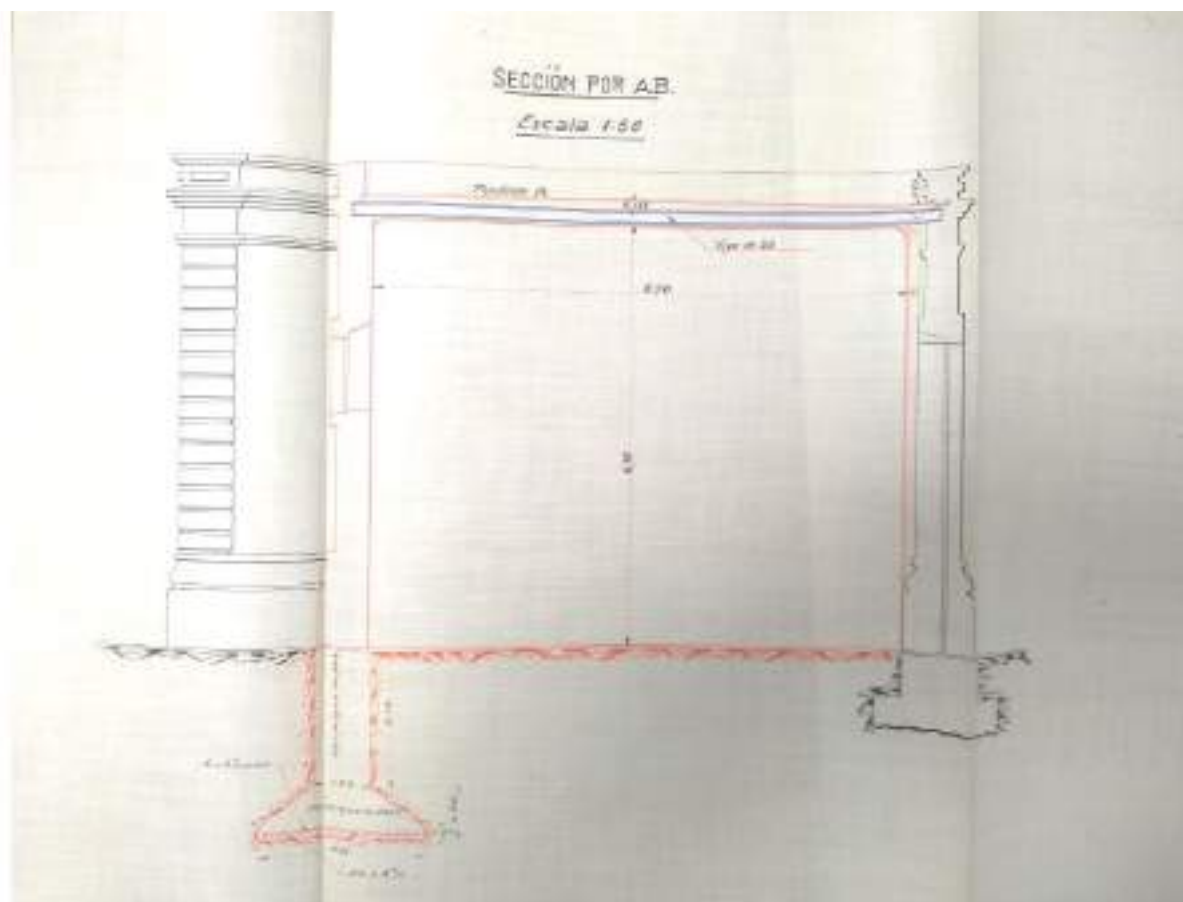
Sección con detalles de la cimentación para el nuevo volumen adosado. Sección por AB (Escala 1:50), 26 de julio de 1930, en "Pabellón con cajonería para el personal de trenes". AHF-MFM., B-0027-006 14-16.
